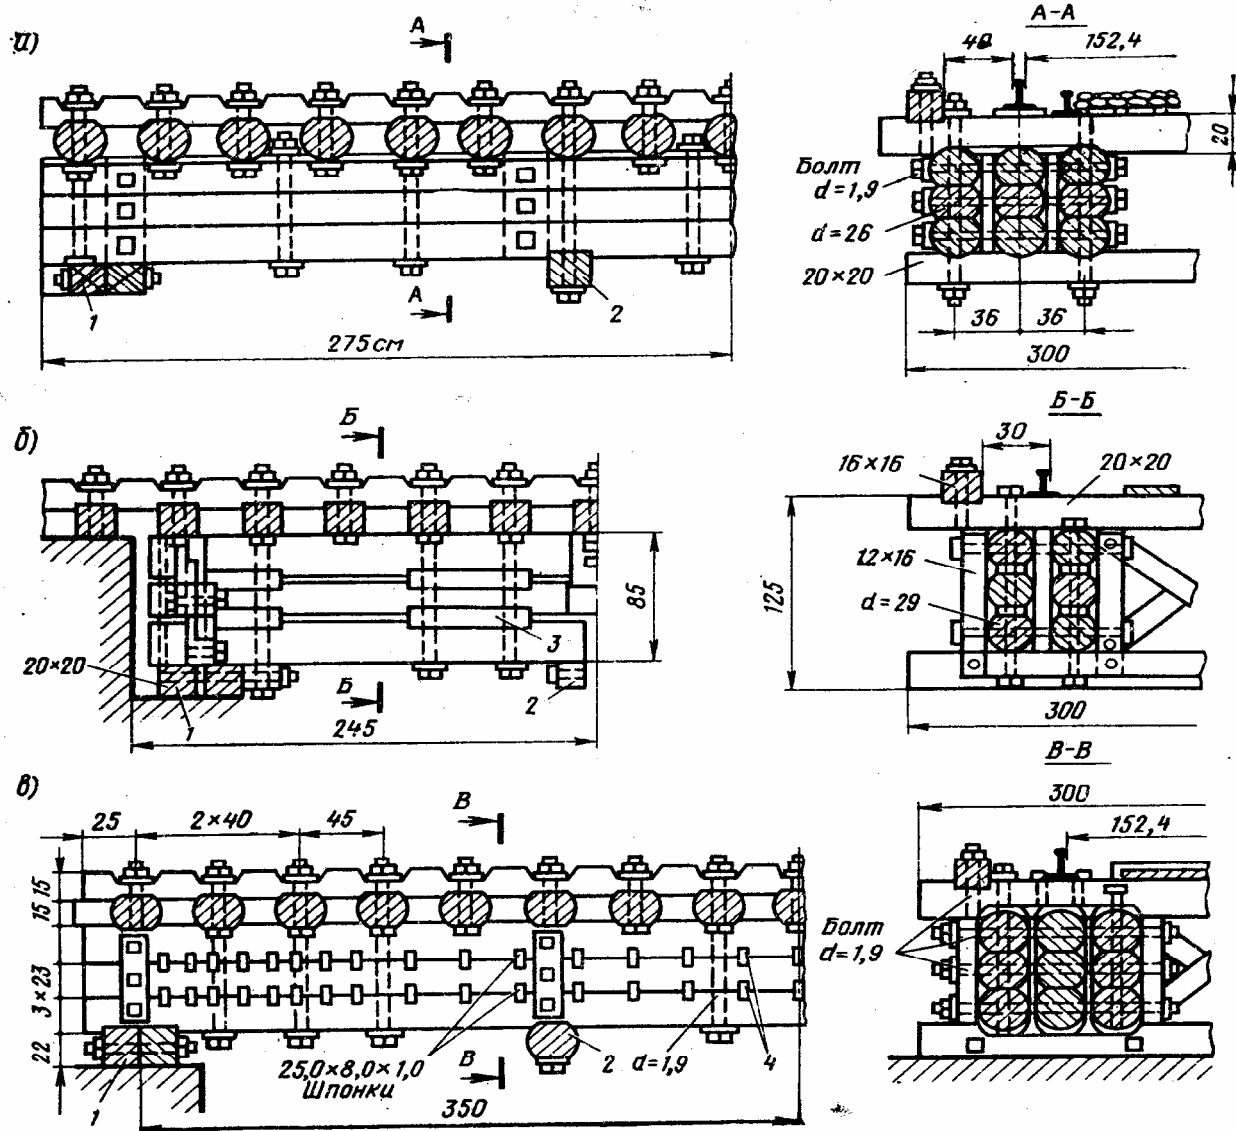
Конструкция пакетных пролетных строений (ПС)
